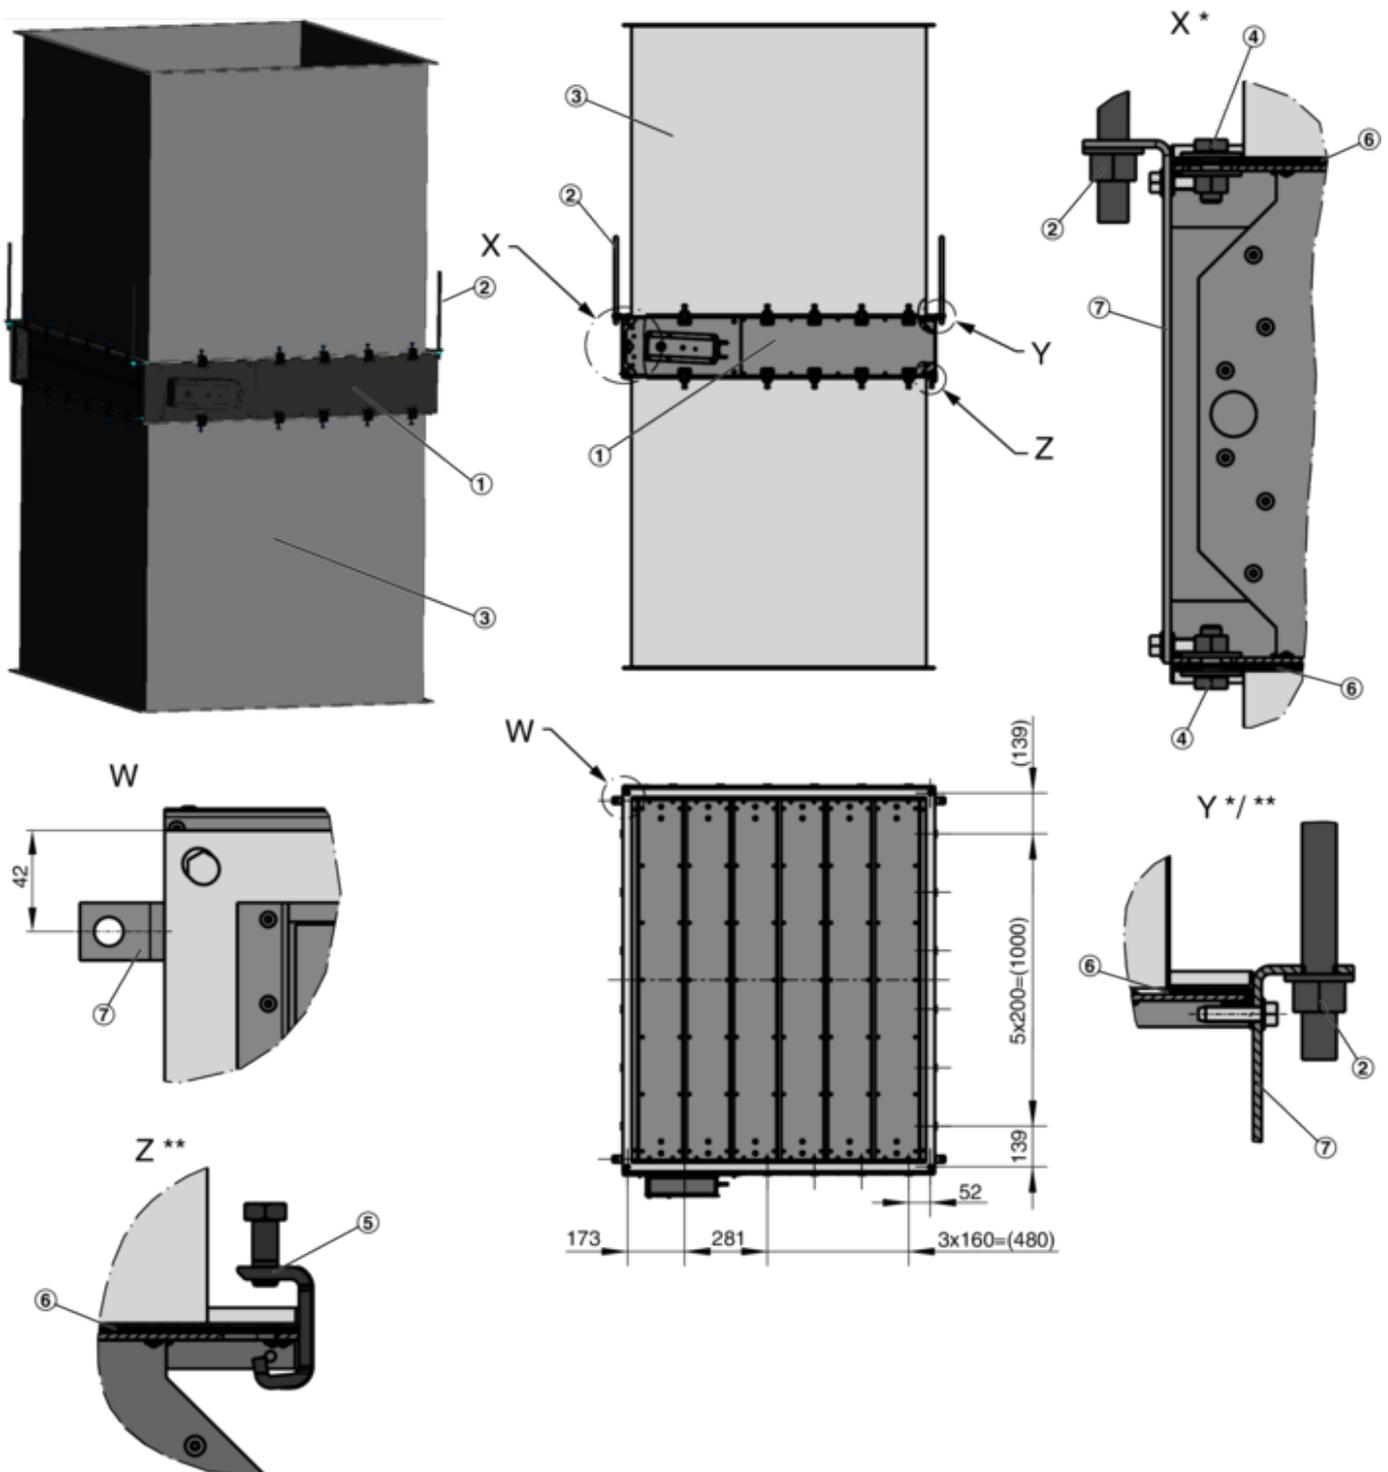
Einbau in einer vertikalen Entrauchungsleitung
